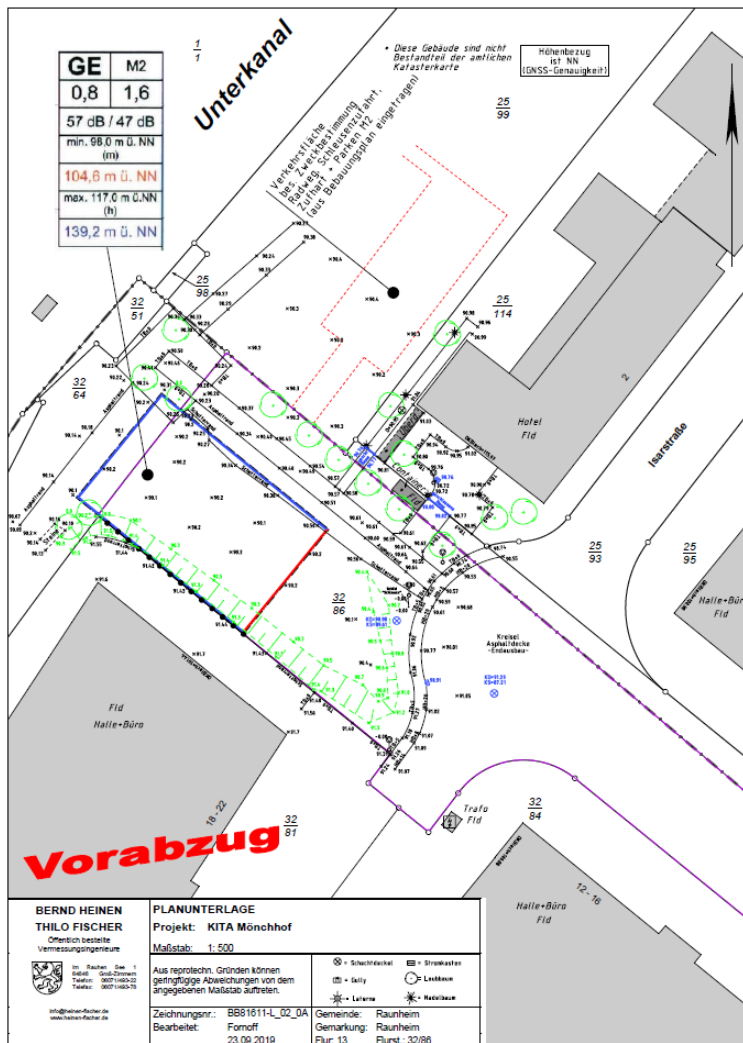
Vorabzug Vermesserplan mit Lage Baufeld M2 gemäß B-plan 61.23.27-1 „Mönchhof“
